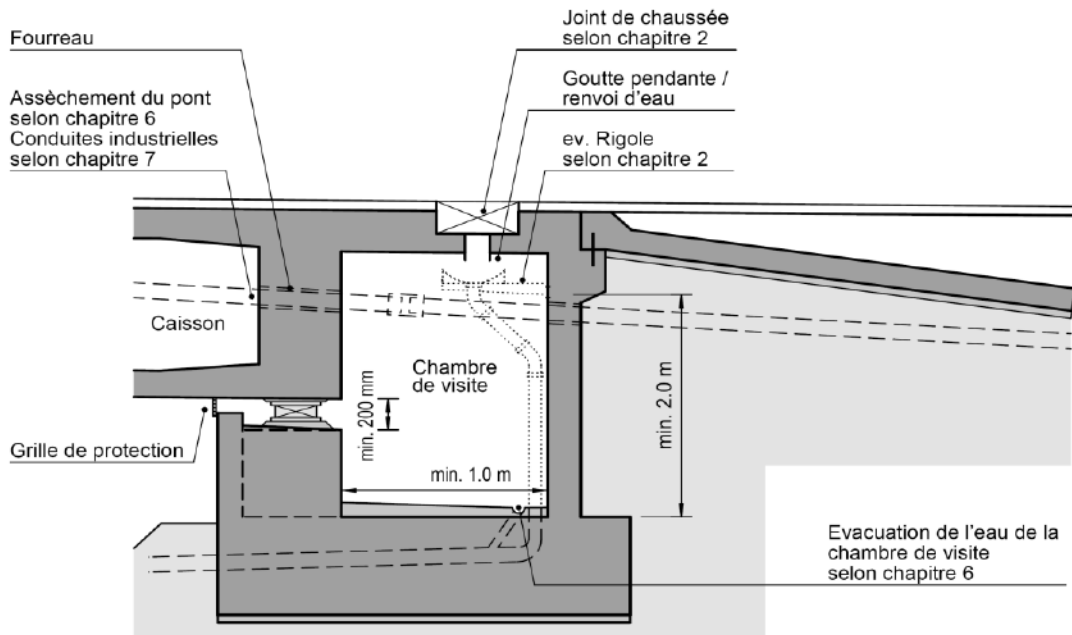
Coupe longitudinale d'une extrémité de pont avec chambre de visite.
